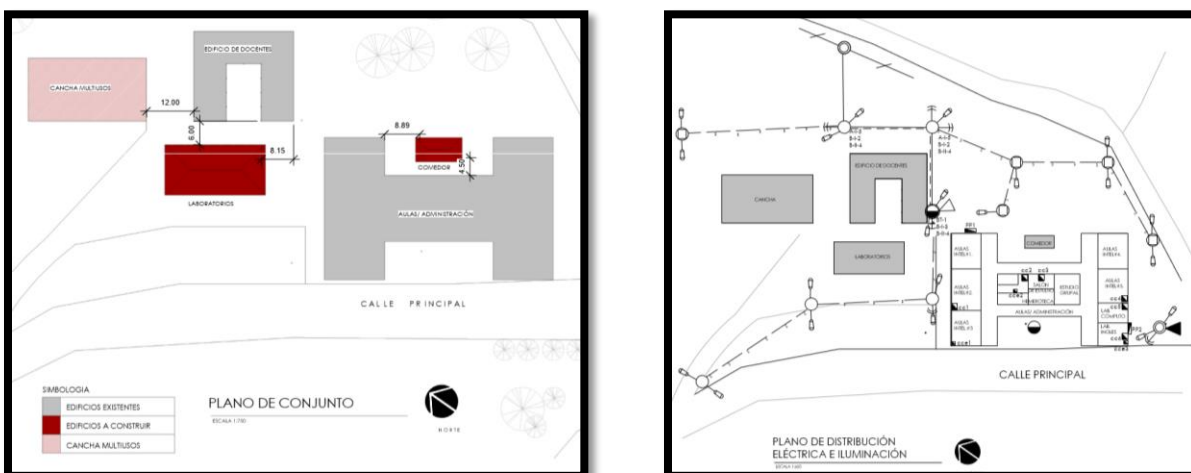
Plano Conjunto – Plano de Distribución Eléctrica e Iluminación.
